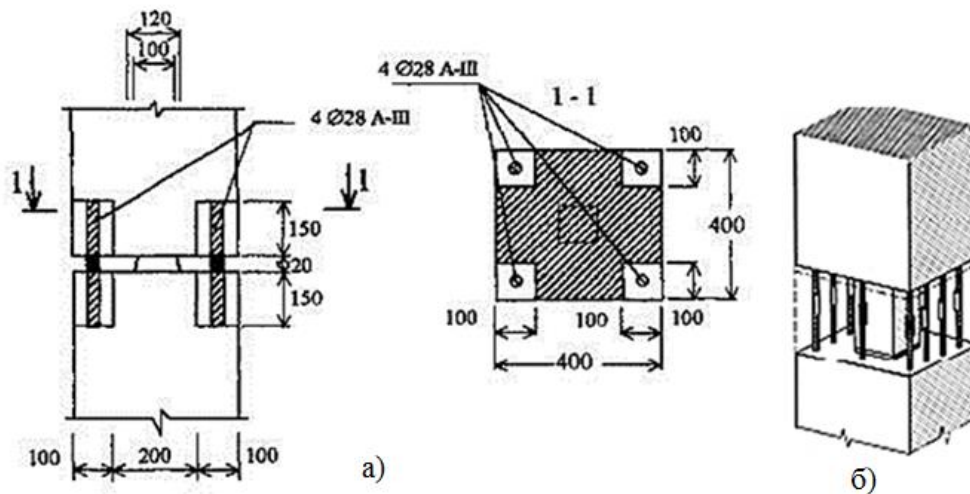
З'єднання колон з фундаментами відкритого типу та колон з колонами попередніх конструктивних рішень:
